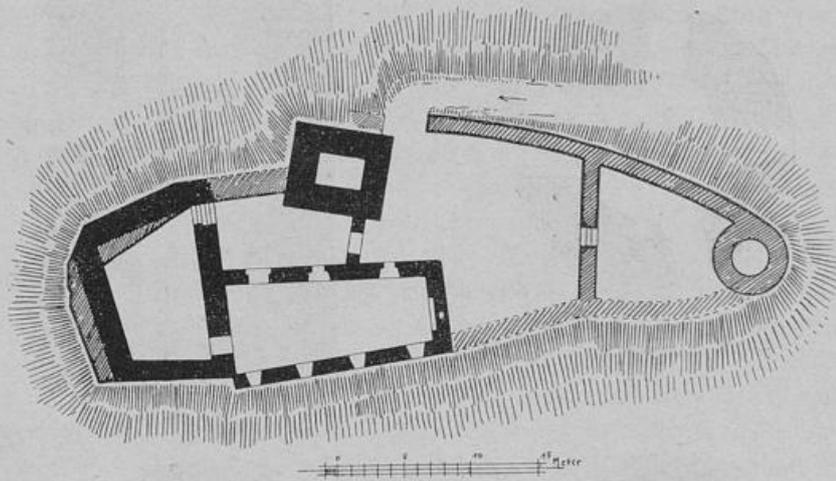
Reinardstein. Grundriss der Burgruine.
